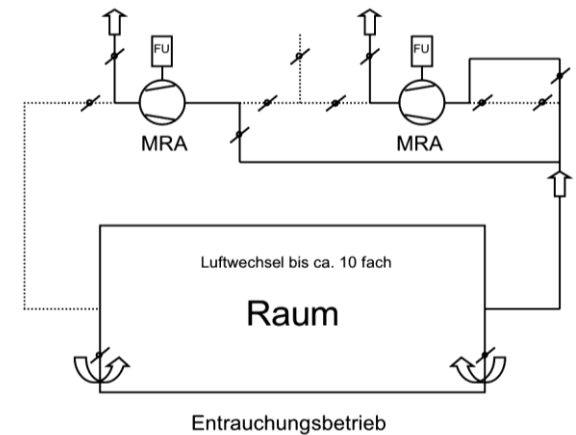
Anlagenschema einer Lüftungsanlage im Entrauchungsbetrieb mit einer Entrauchungsleitung (Lüftung - Abluft)
